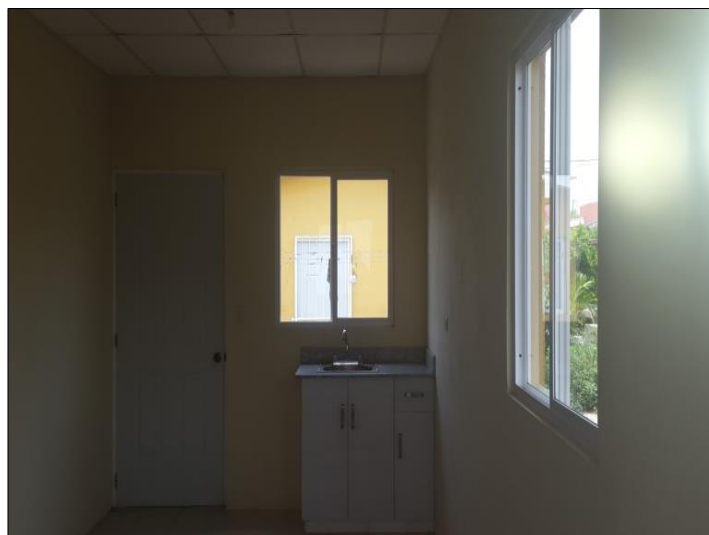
interior de vivienda /Fuente: Elaboración propia.
